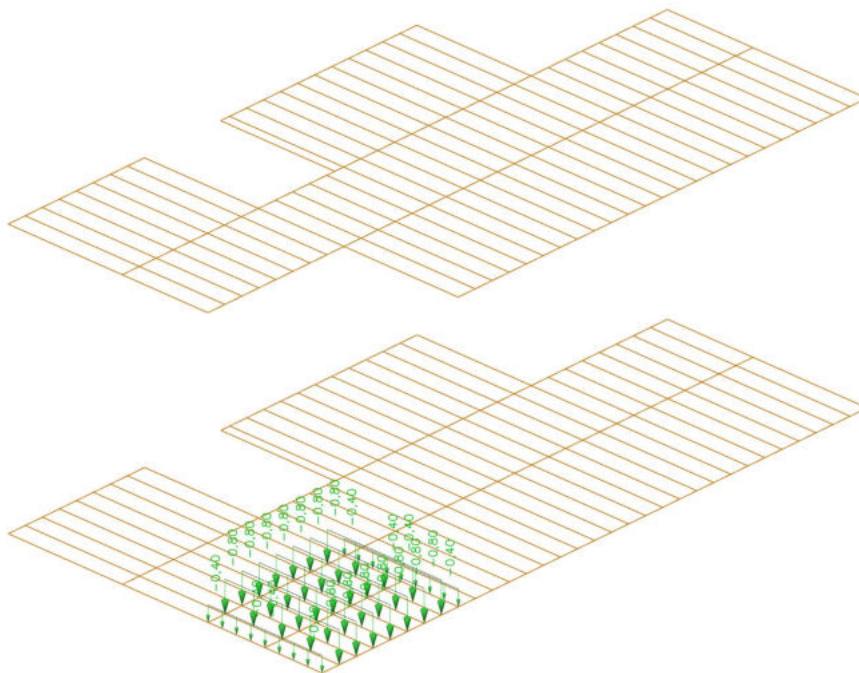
Zatížení stropní konstrukce podélným větrem zprava 1
